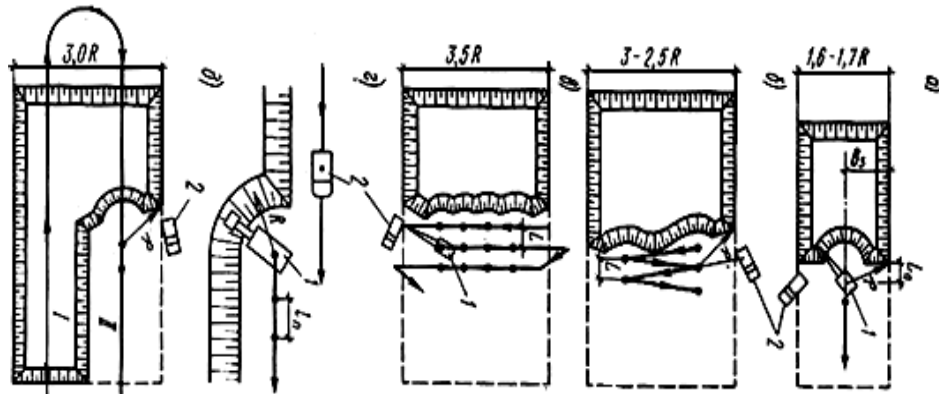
Схемы проходок экскаватора с рабочим оборудованием «обратная лопата» а - лобовая проходка; б - уширенная лобовая; в - поперечно-торцовая; г - боковая проходка; д - разработка котлована двумя лобовыми проходками; I и II - последовательность проходок; 1 - экскаватор; 2 - автосамосвал
